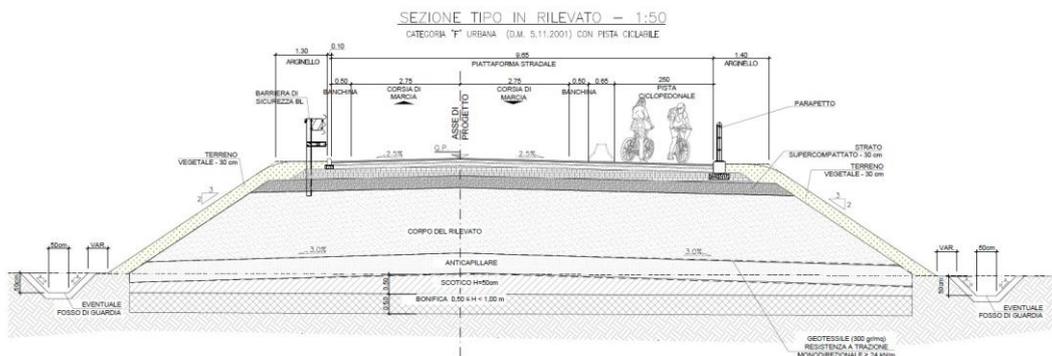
Sezione tipo strada F urbana con pista ciclopedonale
